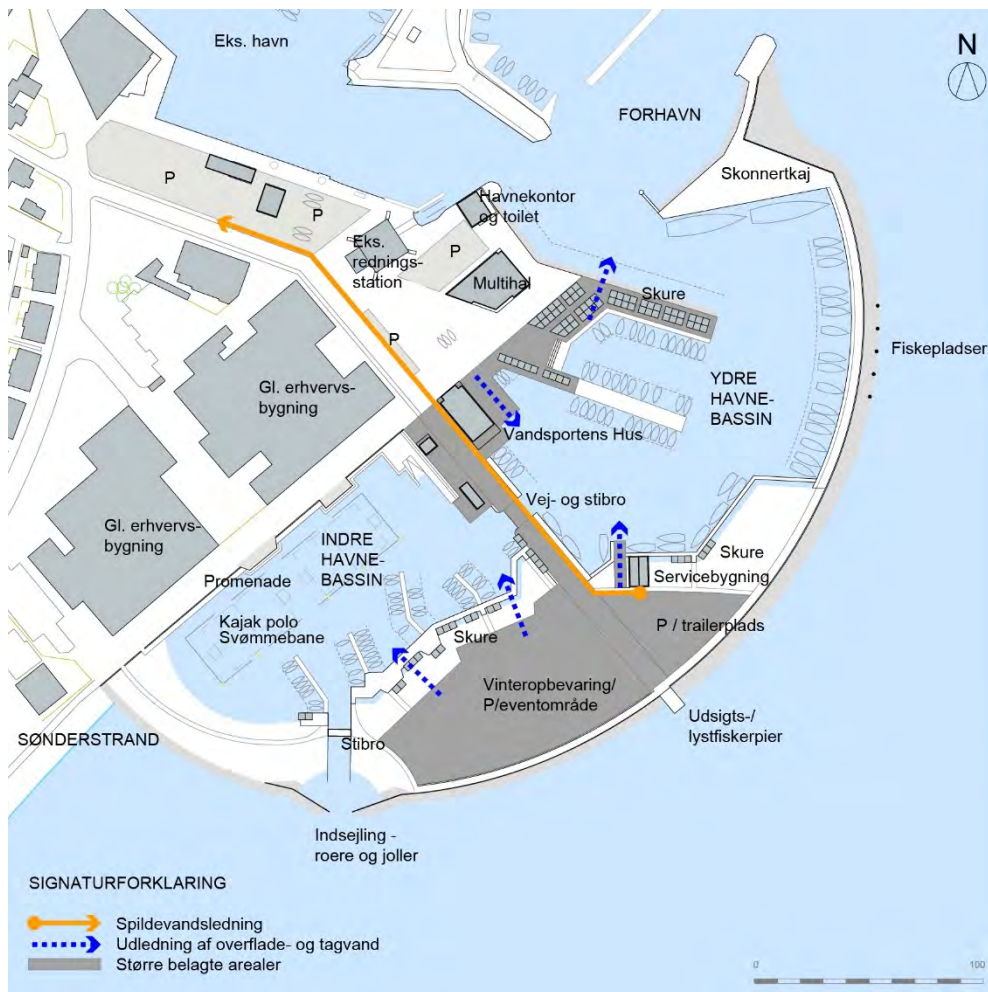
Plan over placering af spildevandsledning og udledninger af overfladevand og tagvand
